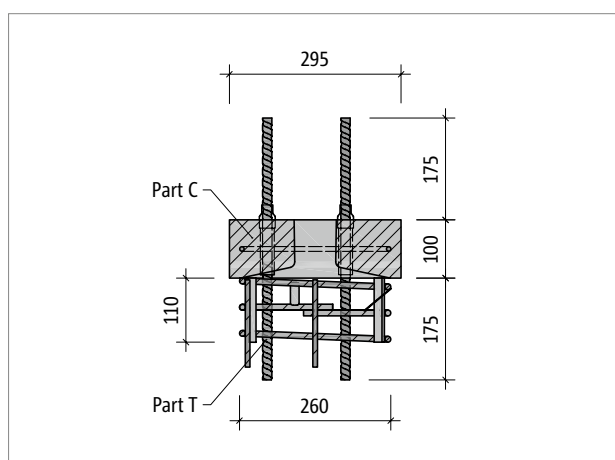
Schöck Sconnex® type P-B300: Aanzicht van bovenaf
